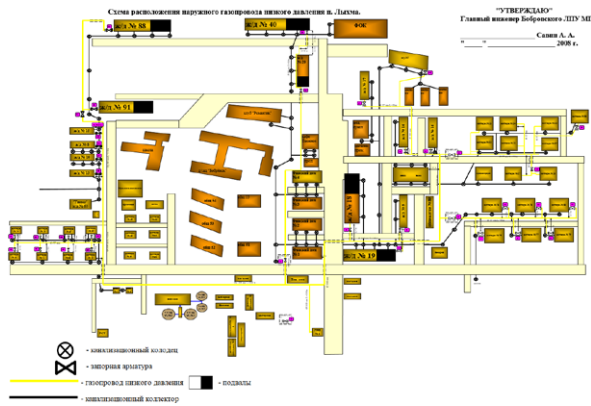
Схема расположения наружного газопровода низкого давления п. Лыхма
